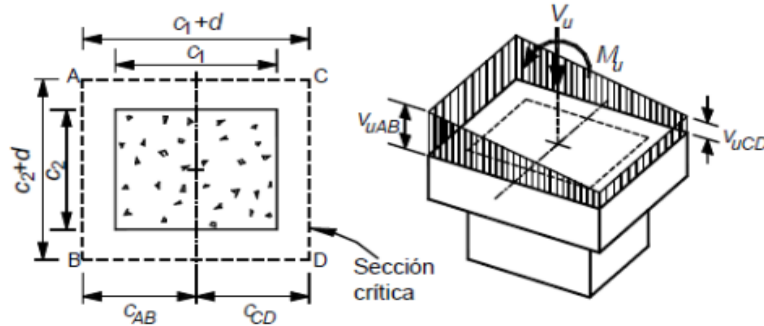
Definición de la sección crítica en la losa plana (NTC-Concreto-2004).
